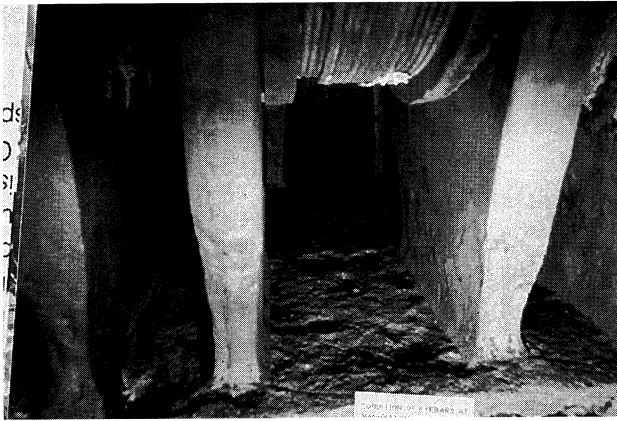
マンハッタン橋 ケーブル定着部の断面欠損
